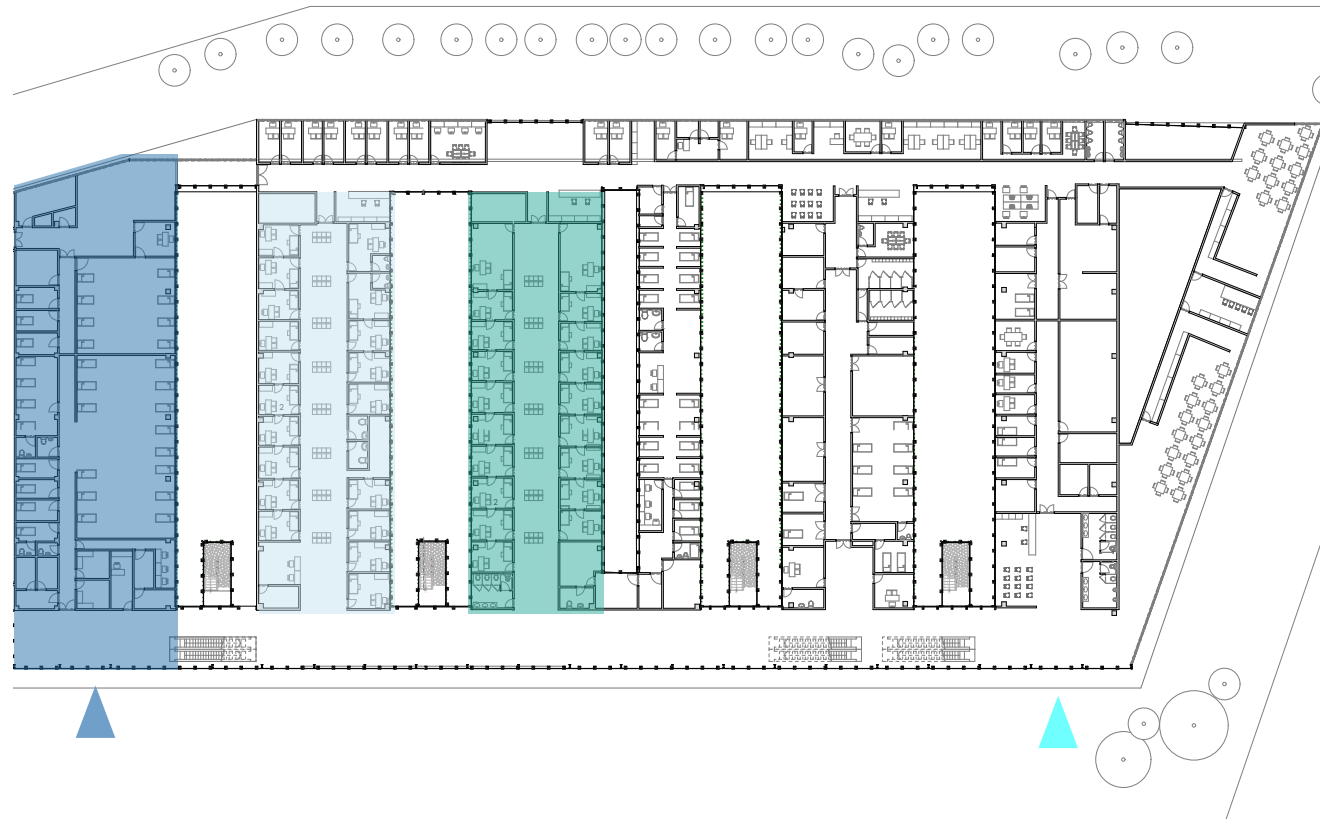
| Plano Arquitectónico (Autores,2020).
